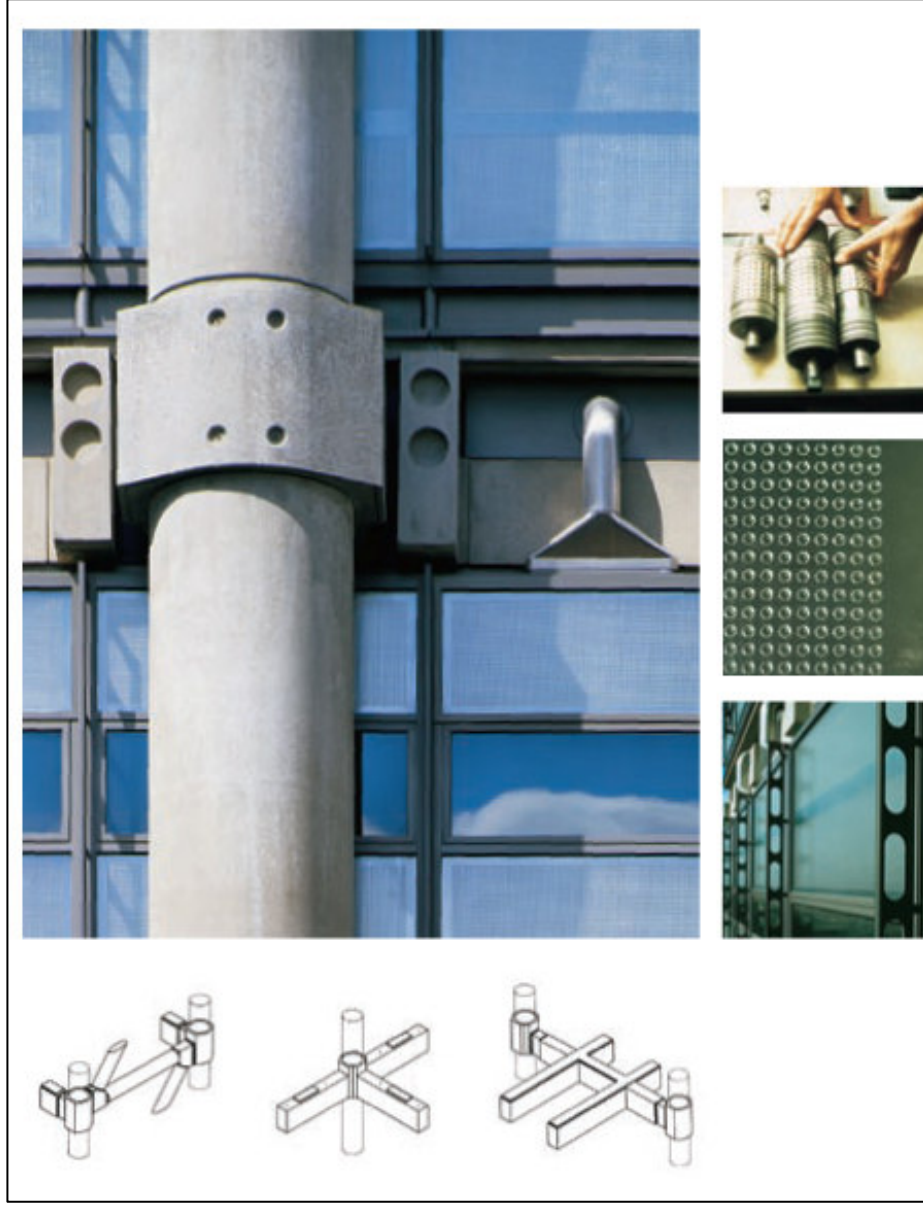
Beton prekast kolonların paslanmaz çelikle kaplanarak oluşturulması [123]
